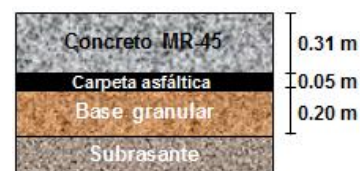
Estructura de pavimento carriles TransMilenio calzada oriental.
